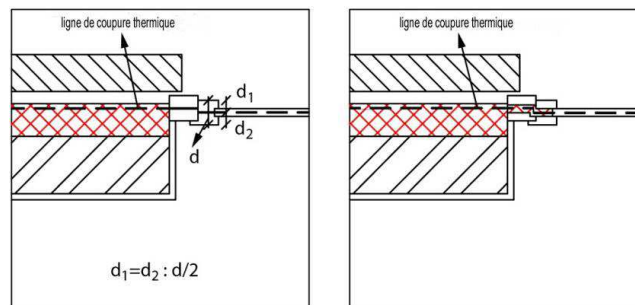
Exemples de lignes de coupure thermique (cas des châssis)
